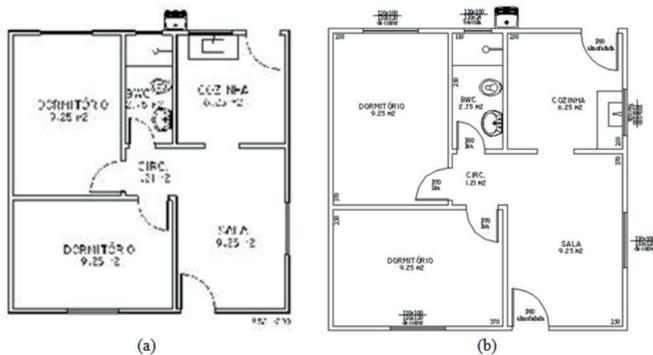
Planta baixa original: a) de Itiquira; b) de Ouro Branco do Sul
